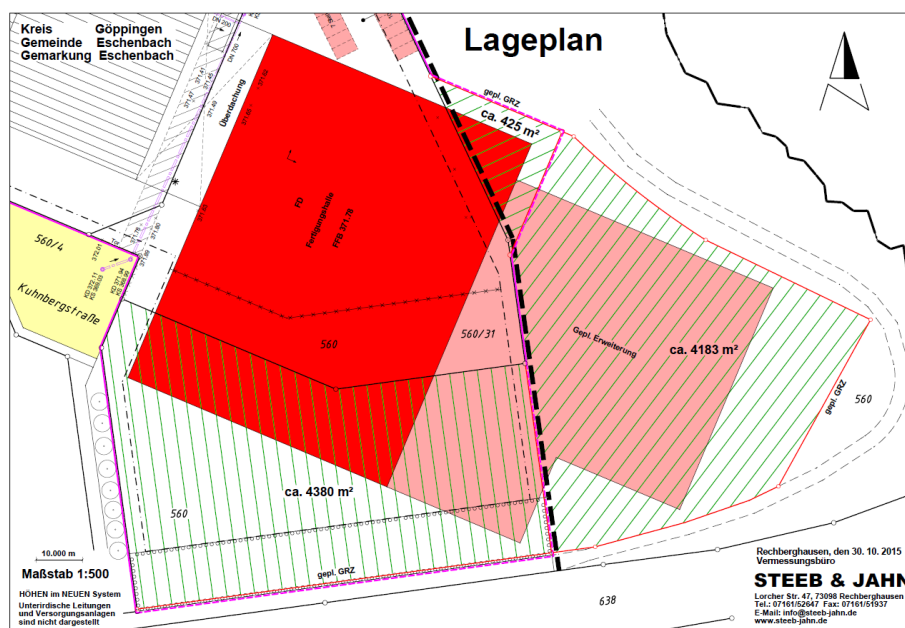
Lageplan des Bauvorhabens (unmaßstäblich; verkleinert).
